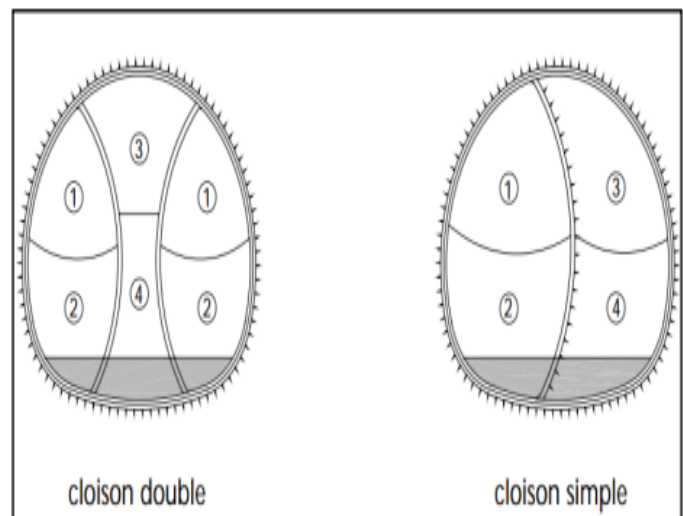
Creusement d'une section divisée[D] Figure I.6 Creusement en sections divisées
